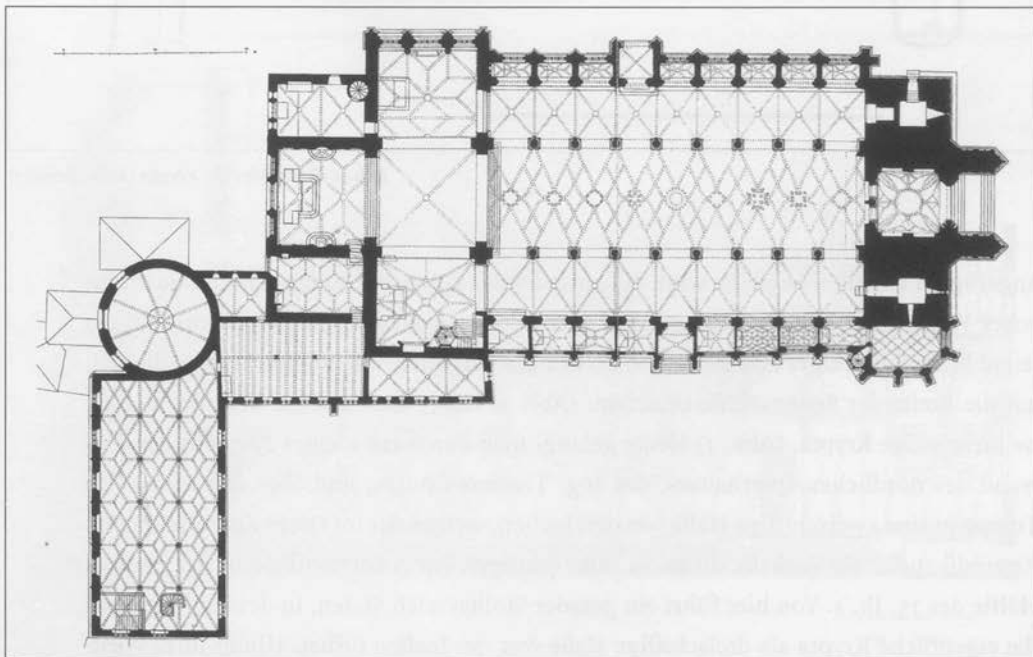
Grundriss des Münsters und der Nebenbauten
